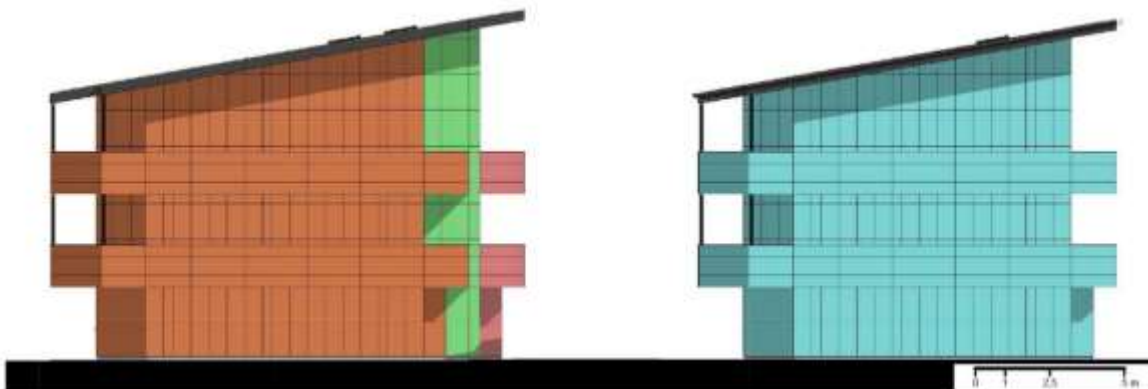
Prospetti est del Complesso 2 e del Complesso 1 rispettivamente. [Fonte: elaborazione dell'autore]
